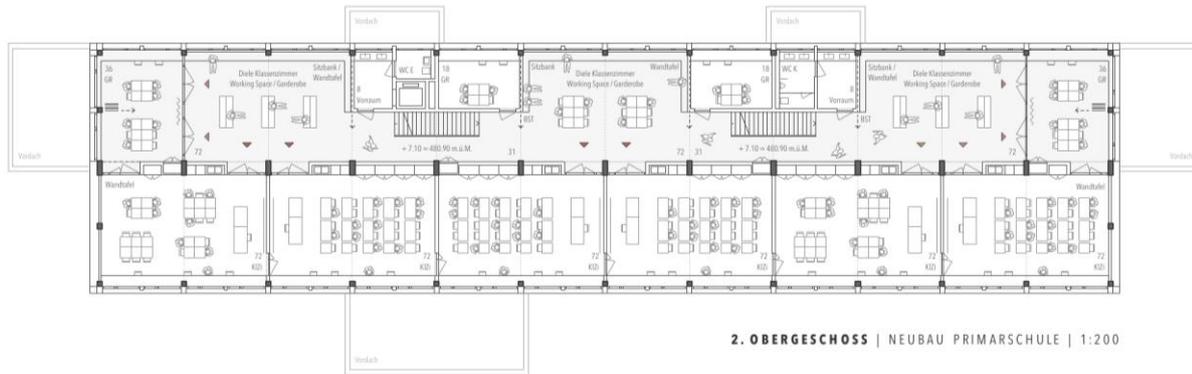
Neubau Primarschule, Grundriss 2. Obergeschoss
